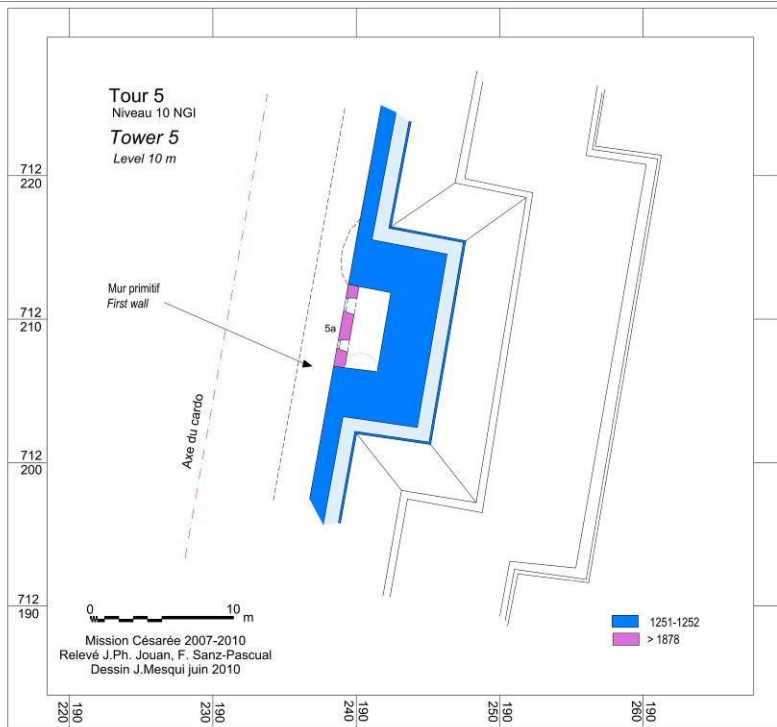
Plan de la tour T5 au niveau 10 m ASL
